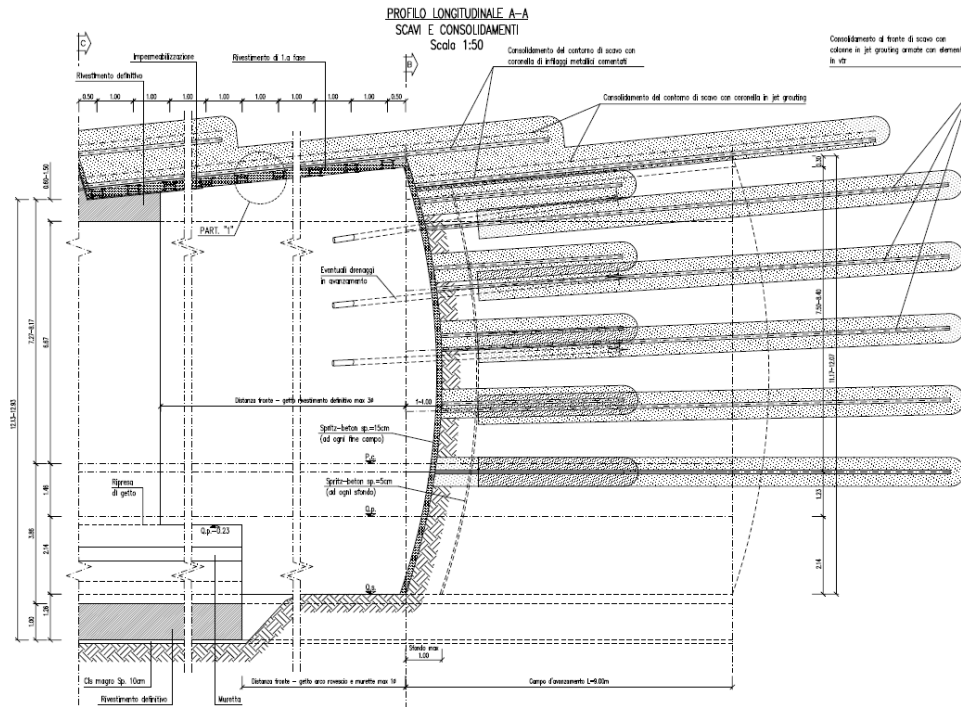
Sezione tipo C1b* (profilo longitudinale)
